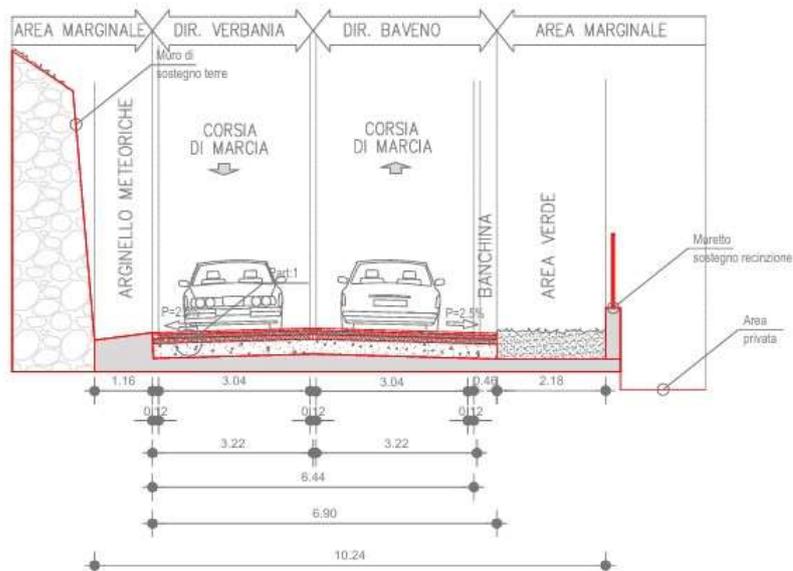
SEZIONE 4 TRATTO VIA 42 MARTIRI ALL'ALTEZZA DELL'INTERSEZIONE CON VIA ARNOLD
